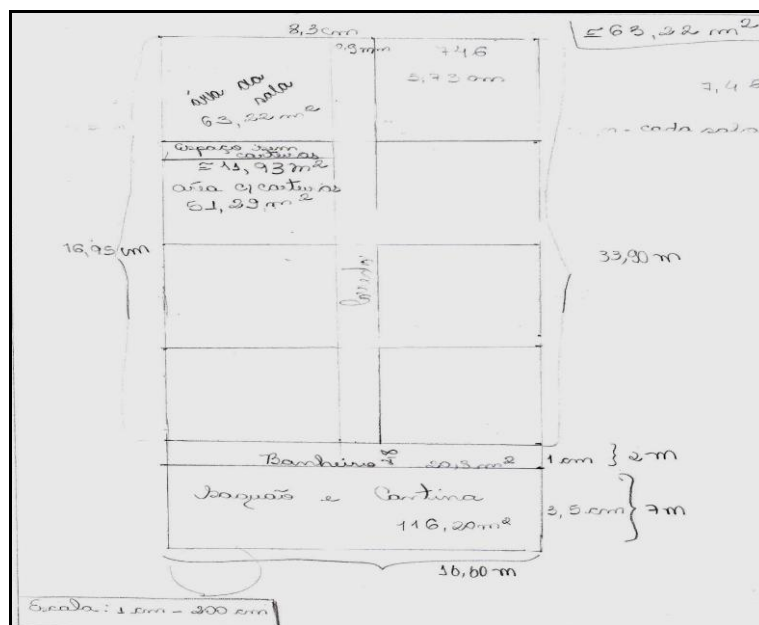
Planta do Bloco 1 da Escola, elaborada pelo grupo 2.
